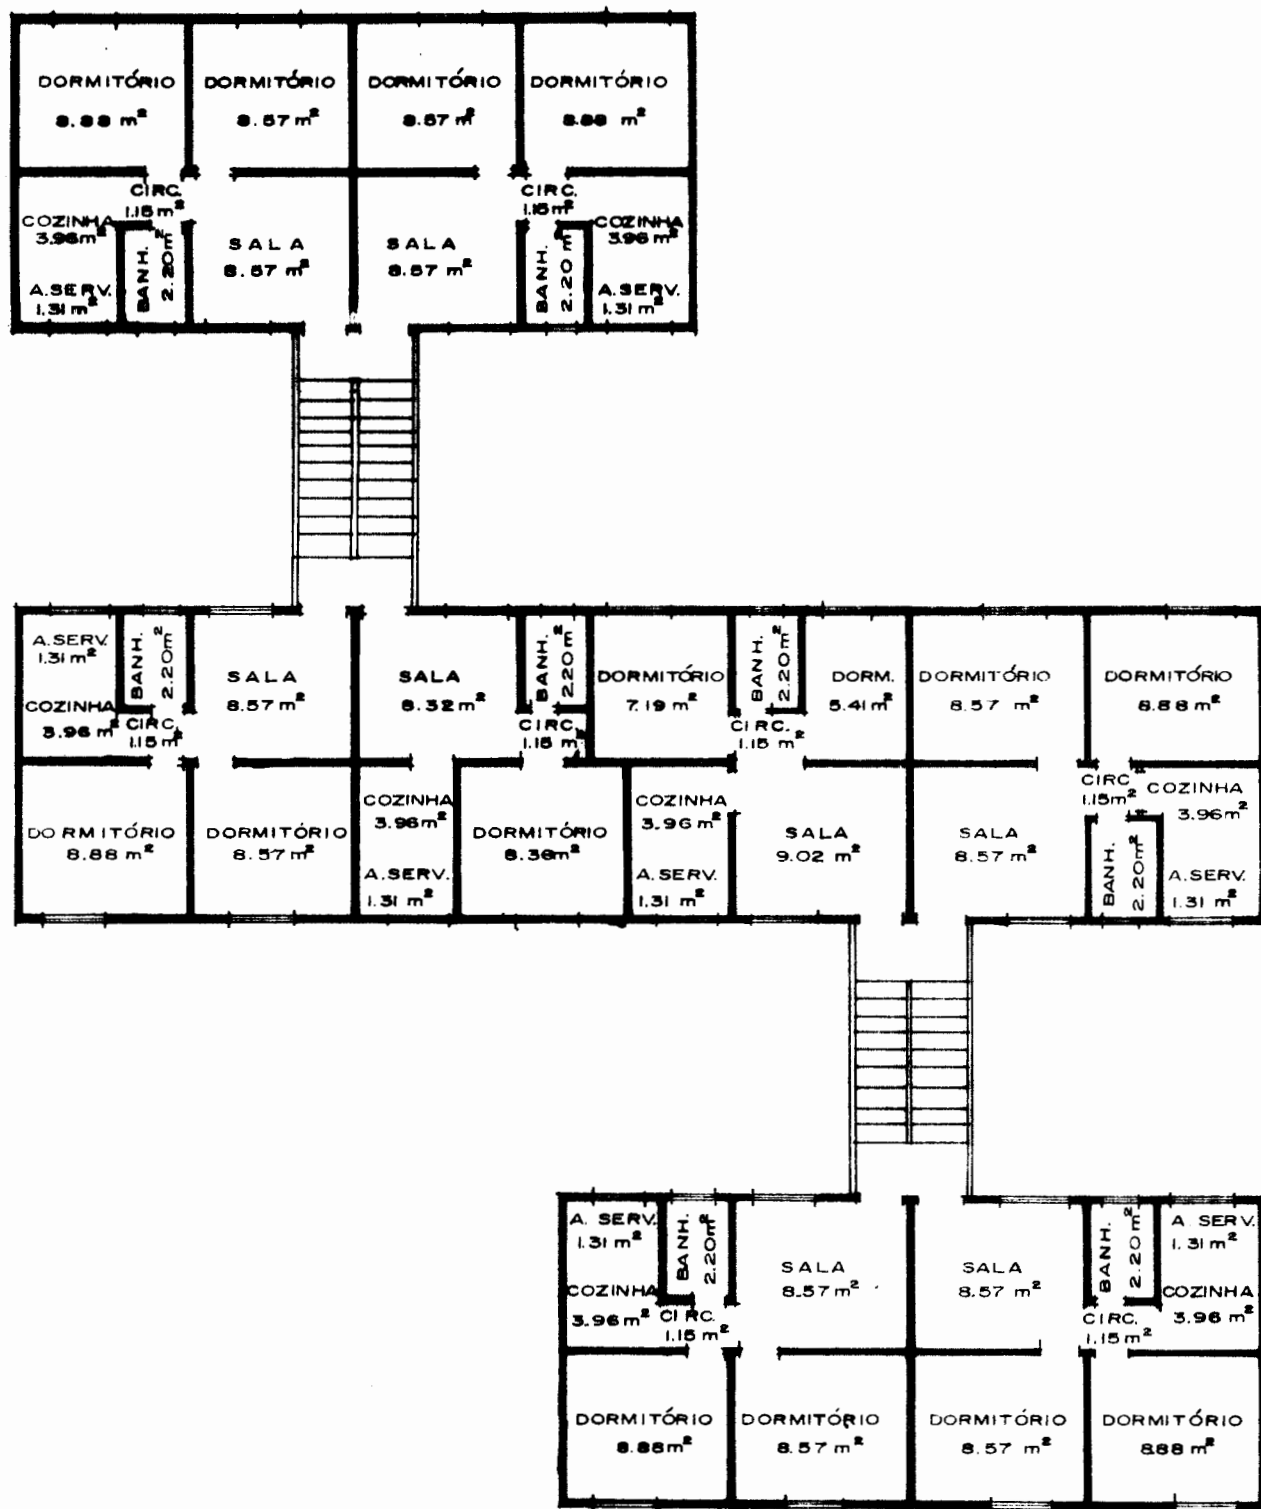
= Pavimento tipo bloco de apartamentos Conjunto Sapucaia do Sul
